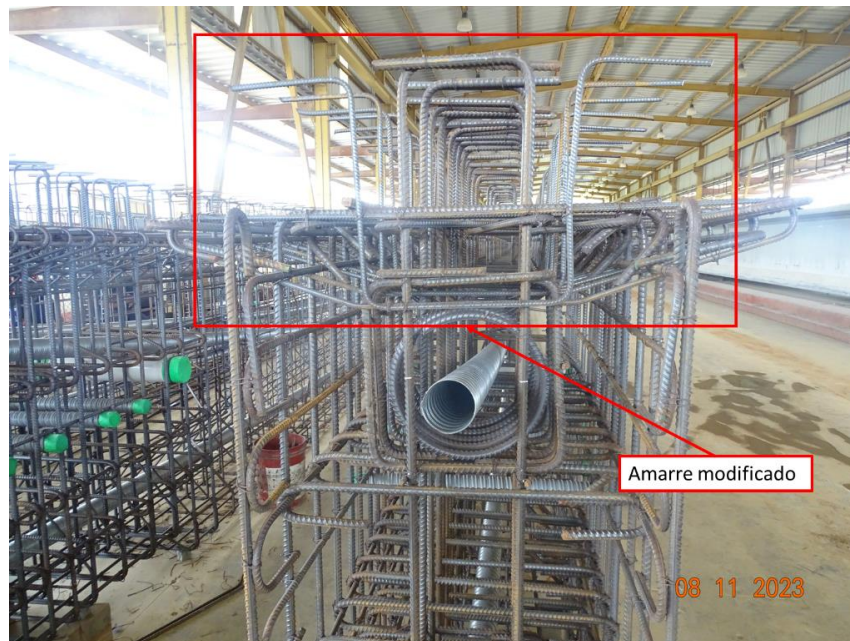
Modificación de varilla tipo V7 en viga de superestructura n.º 4
